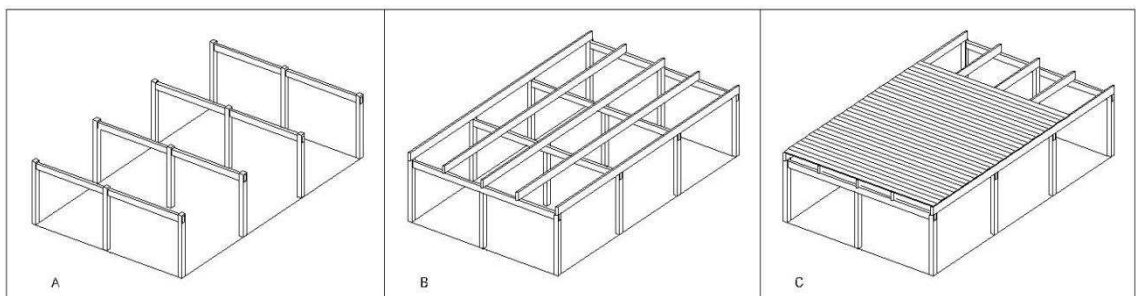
(a) Pilar e viga primária; (b) viga secundária ; (c) assoalho em madeira.
